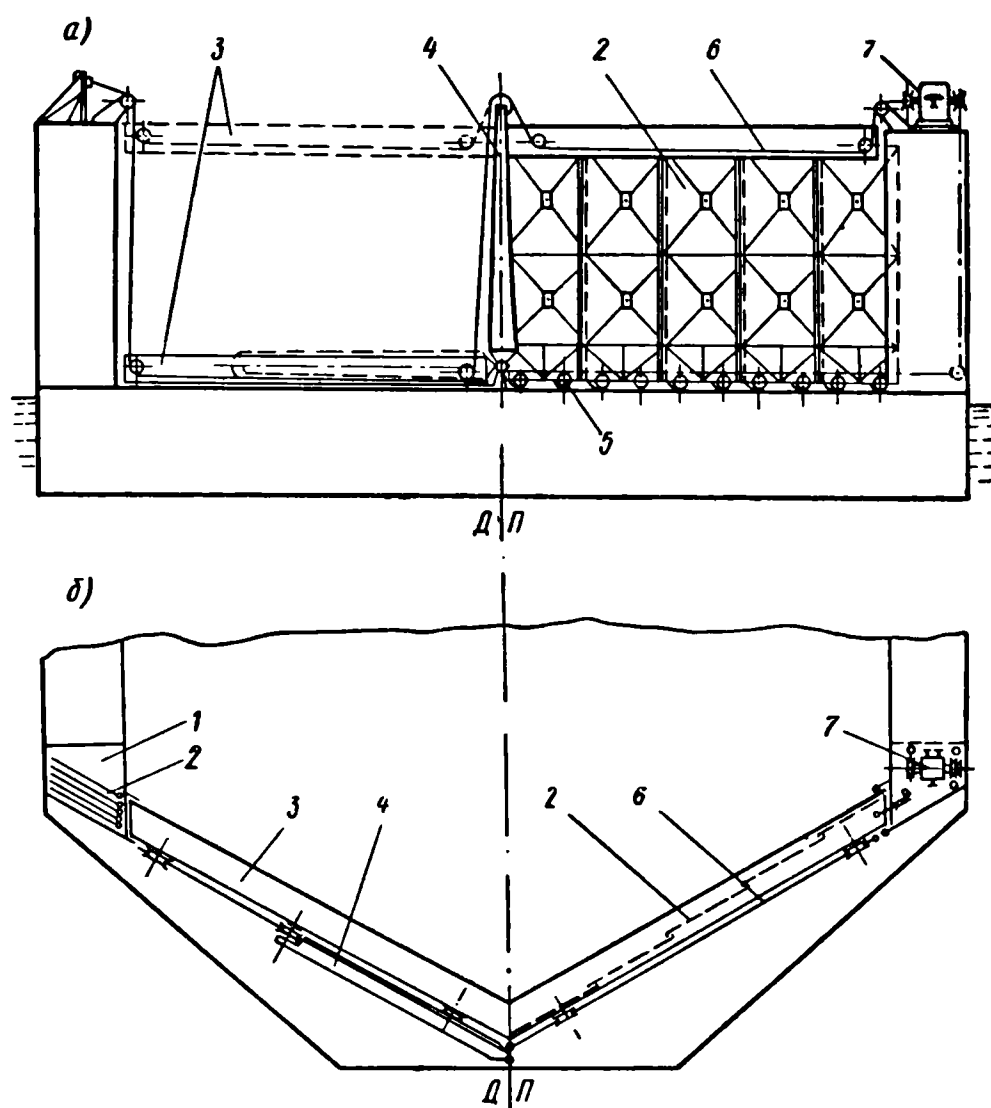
Раздвижное закрытие: а — вид на торец дока; б — план.
